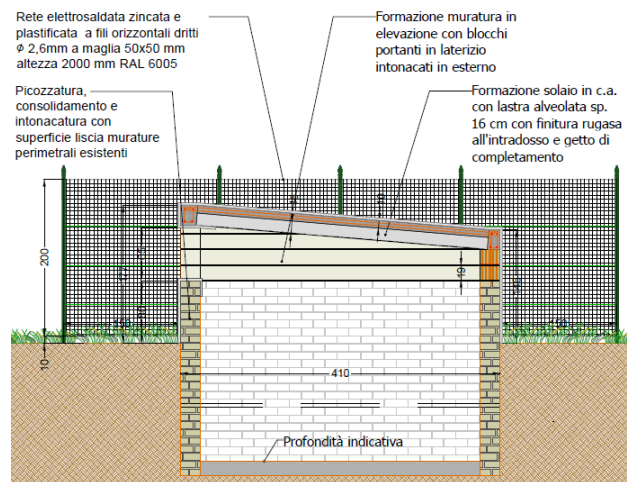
Stato di fatto e sezione di progetto della cisterna
